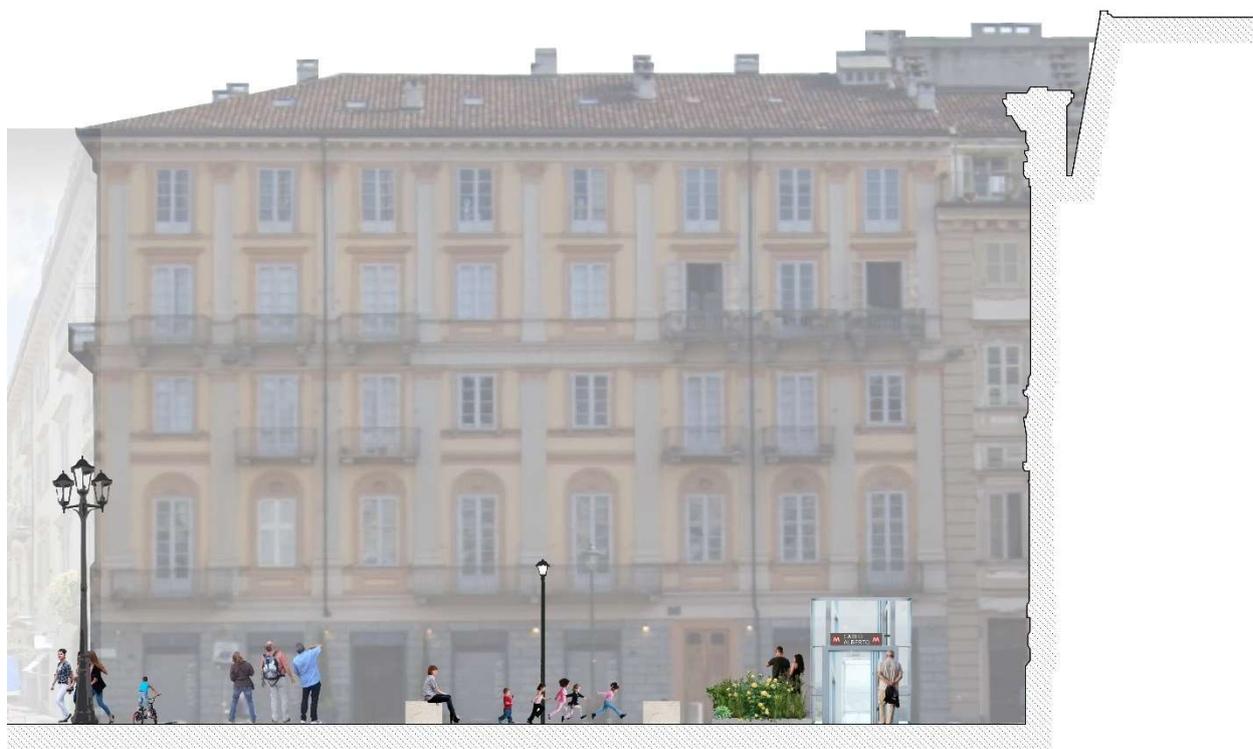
Stazione Carlo Alberto – Sezione verso nord – Progetto – Vista verso via Po
